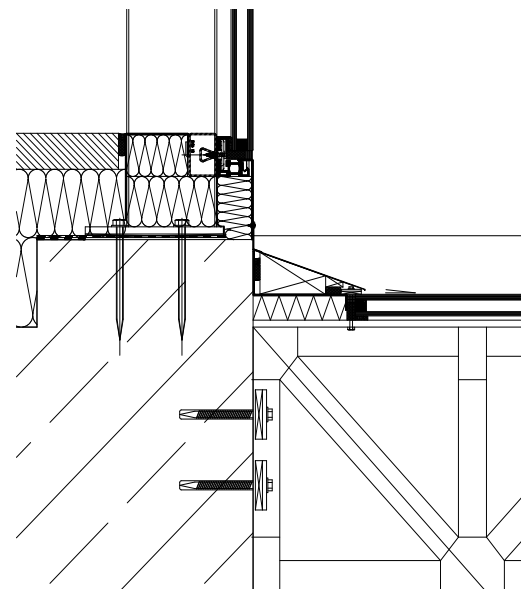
Glasdach Innenhof Anschluss an Geschosdecke: M 1: 10
